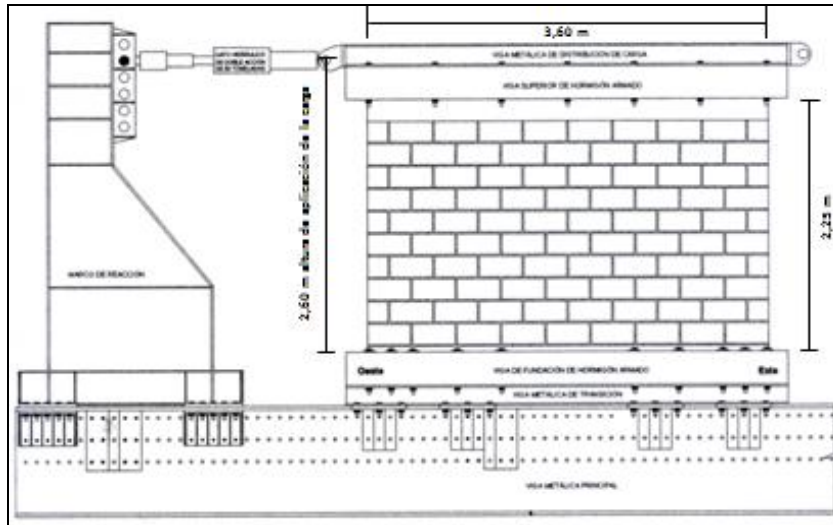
Dispositivo de Ensayo y altura de aplicación de la carga
